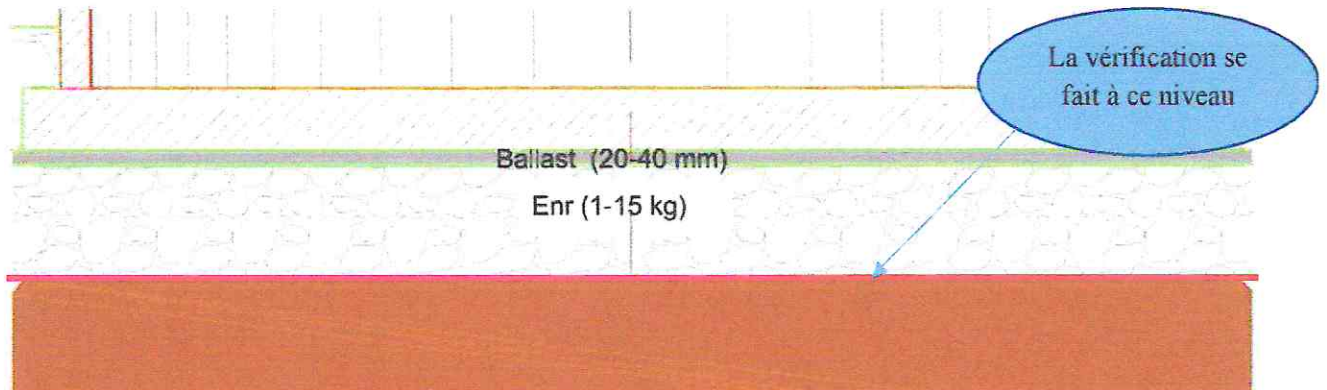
Surface de contact structure + enrochement sur sol de fondation
